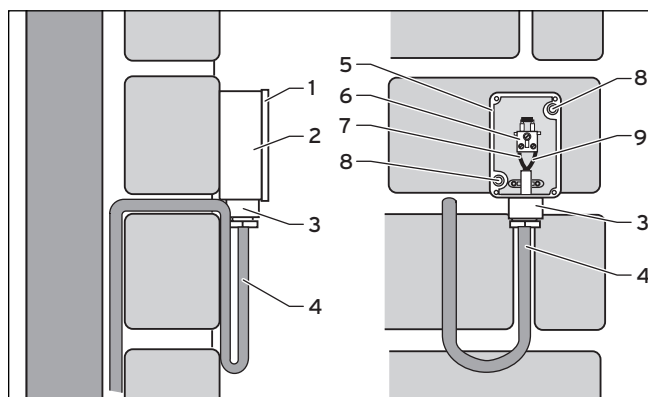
Montaggio della sonda esterna e posizione di montaggio
